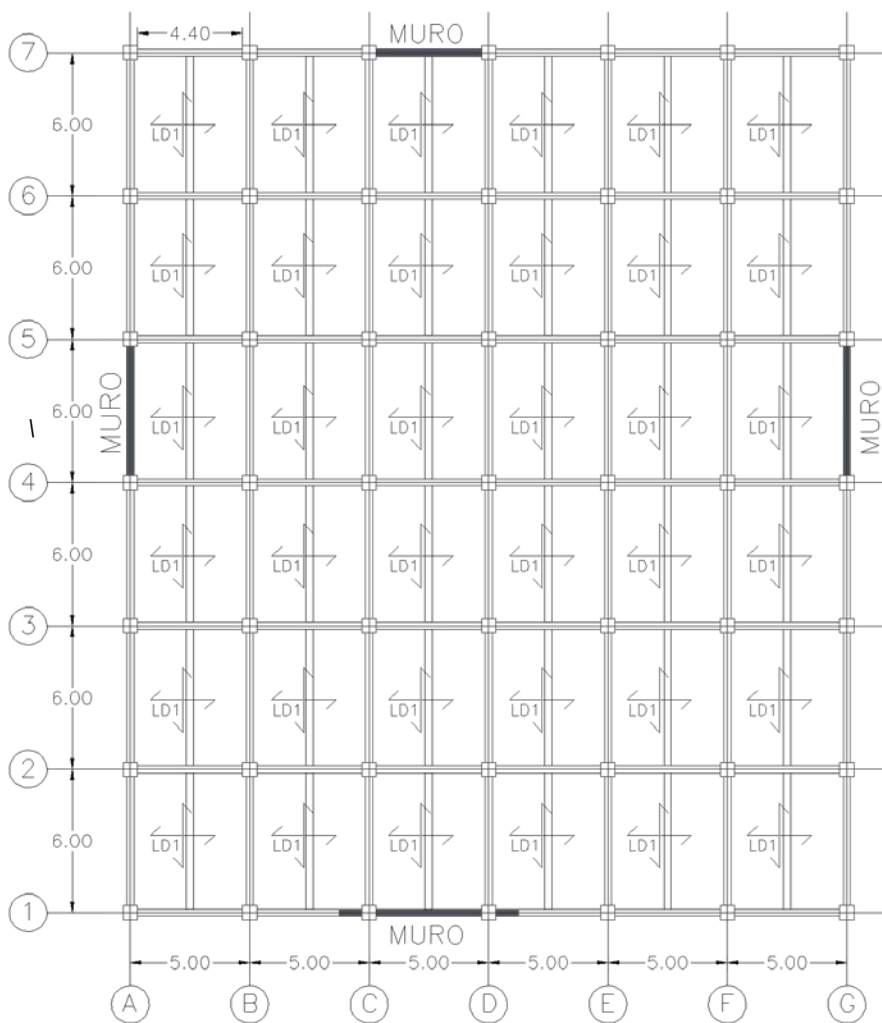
a Planta de Edificio de Seis Niveles (Análisis Estático)
